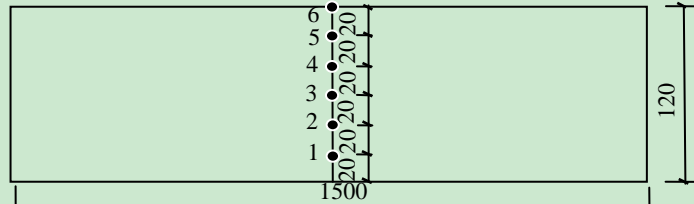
钢筋混凝土板的测温点布置(单位: mm)
